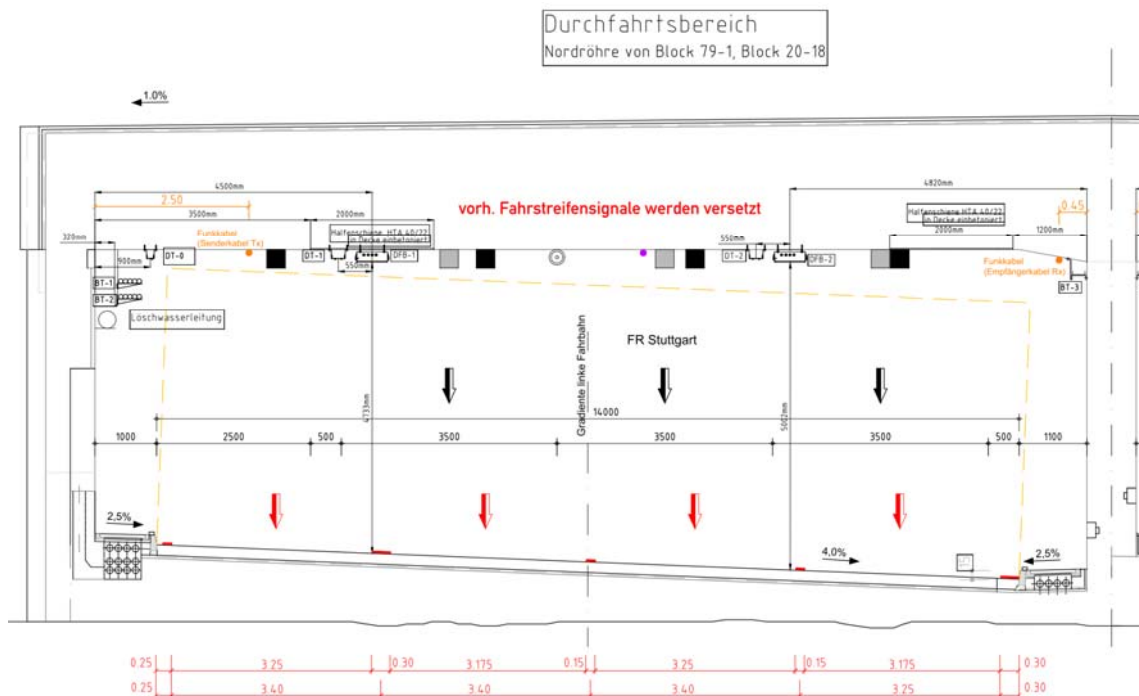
Fahrstreifenmarkierungen Tunnel Allach FR Stuttgart (Quelle: ABDS)
